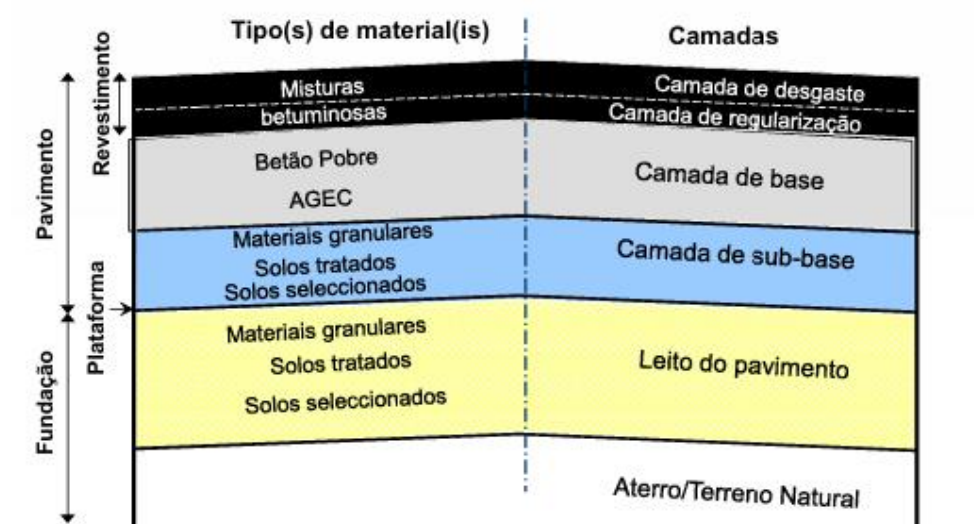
Estrutura de um pavimento semi-rígido. Fonte: Fontul (2023).
